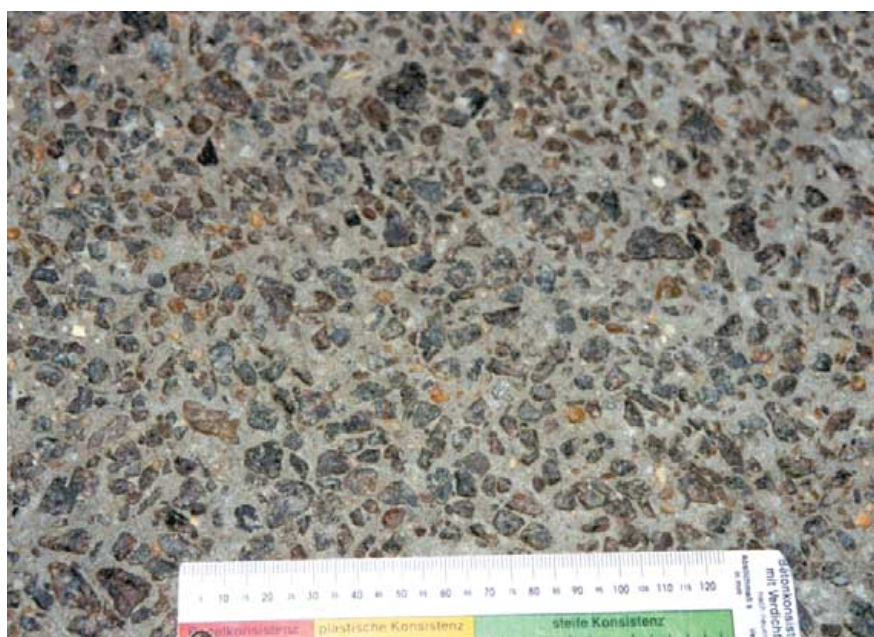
Túnel de Cointe (Lieja): pavimento denudado.
